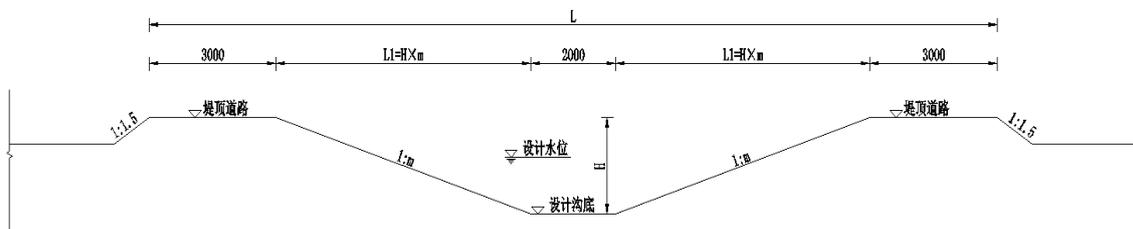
新开沟道标准横断面示意图（单位：mm）
